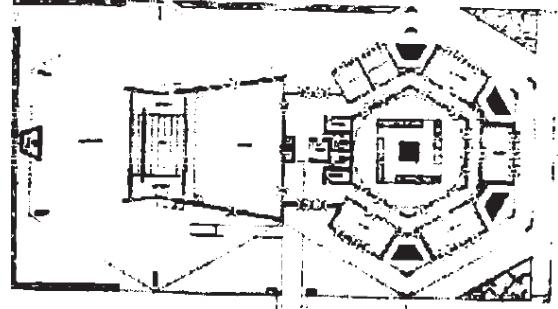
Huzurevi, tiyatro ve mesleki rehabilitasyon planı (Çadırcı, 1991, s. 184-285-287).
